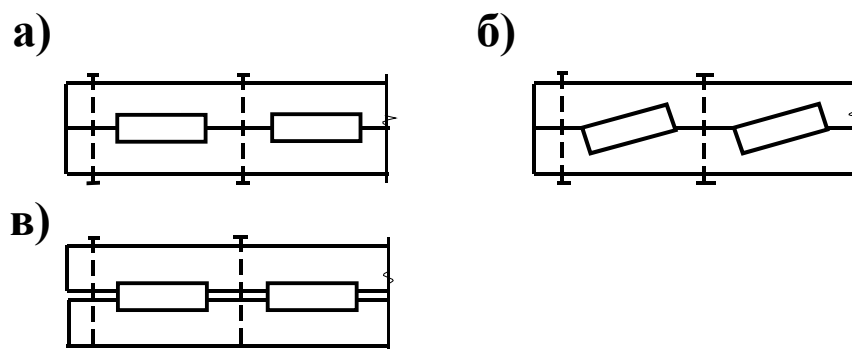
Составные балки на шпонках (а, б) и колодках (в)
